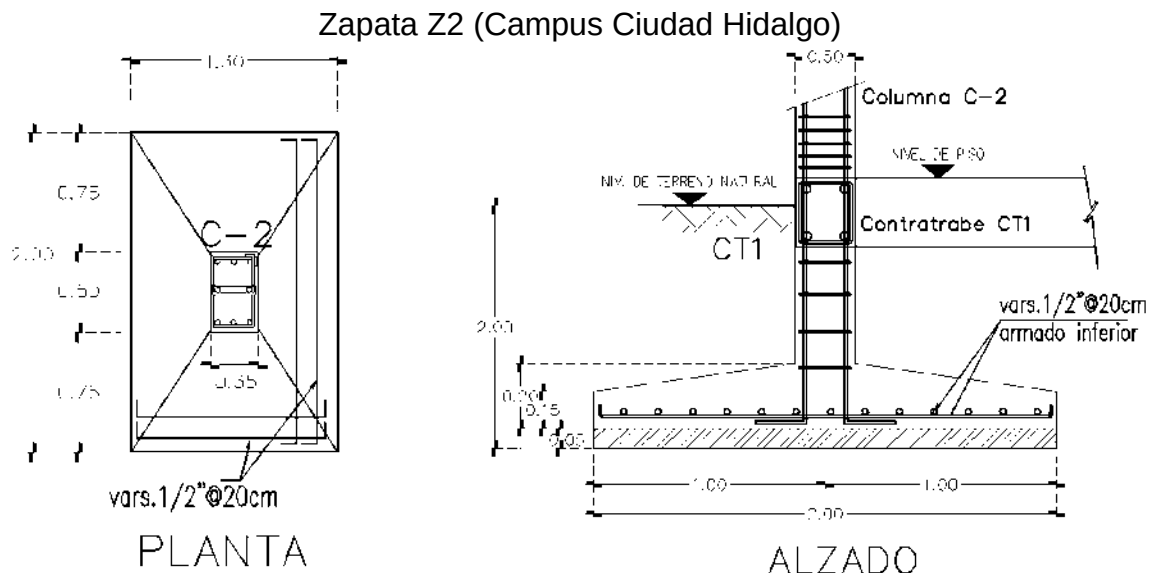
(Planta y alzado de la zapata Z2 original).
